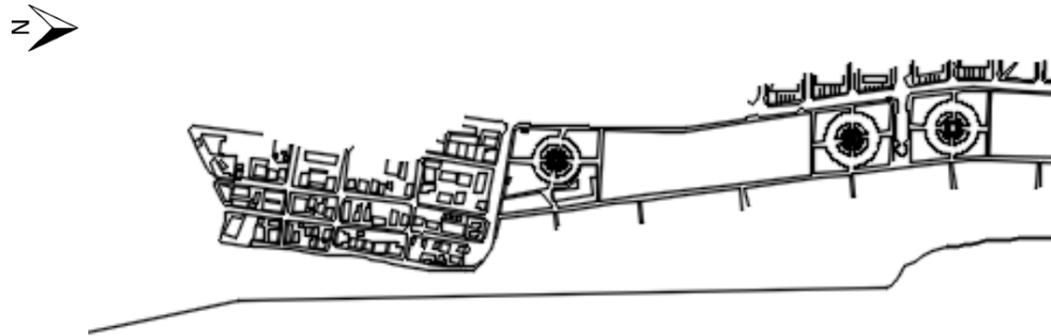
Forma en planta de la alternativa 1: sin estructuras rígidas. Fuente: Elaboración propia.
